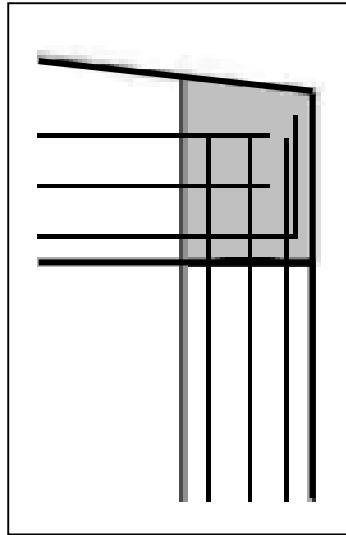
Conexión viga – columna, hormigonada en sitio.
